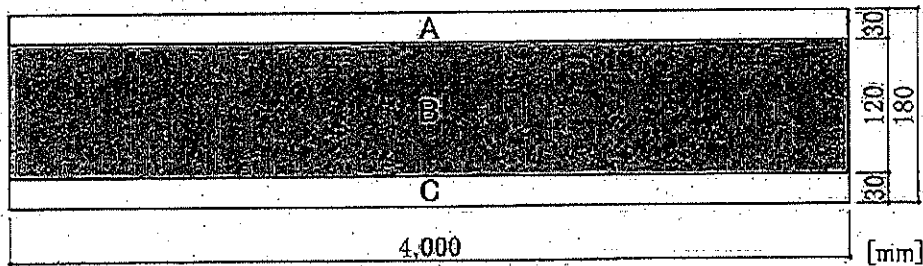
含水率測定位置 (平面図: 外層はヒノキ、内層はスギ)
